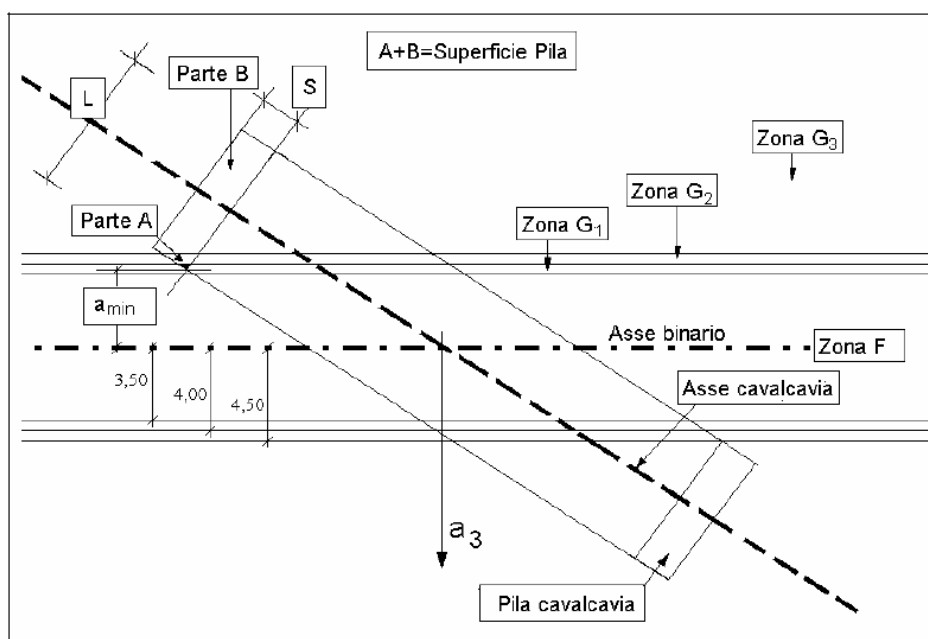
Zone di rispetto orizzontali
